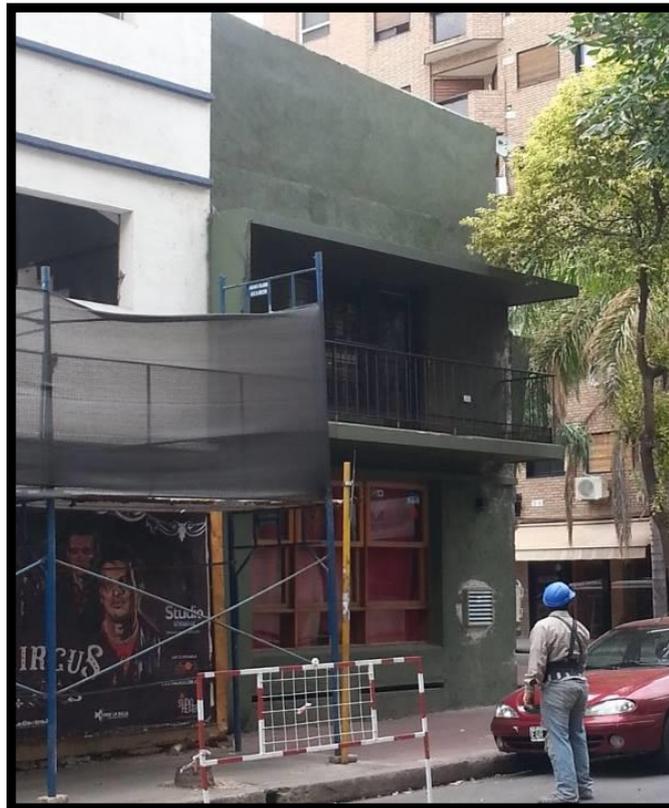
Boliche Aura Fachada sobre calle Buenos Aires. Ubicación C del croquis
